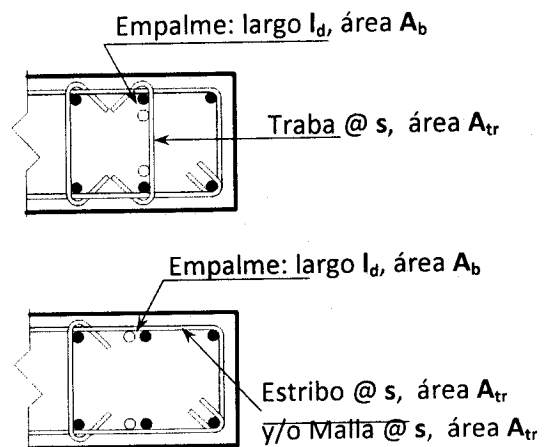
Refuerzo transversal en empalmes.
